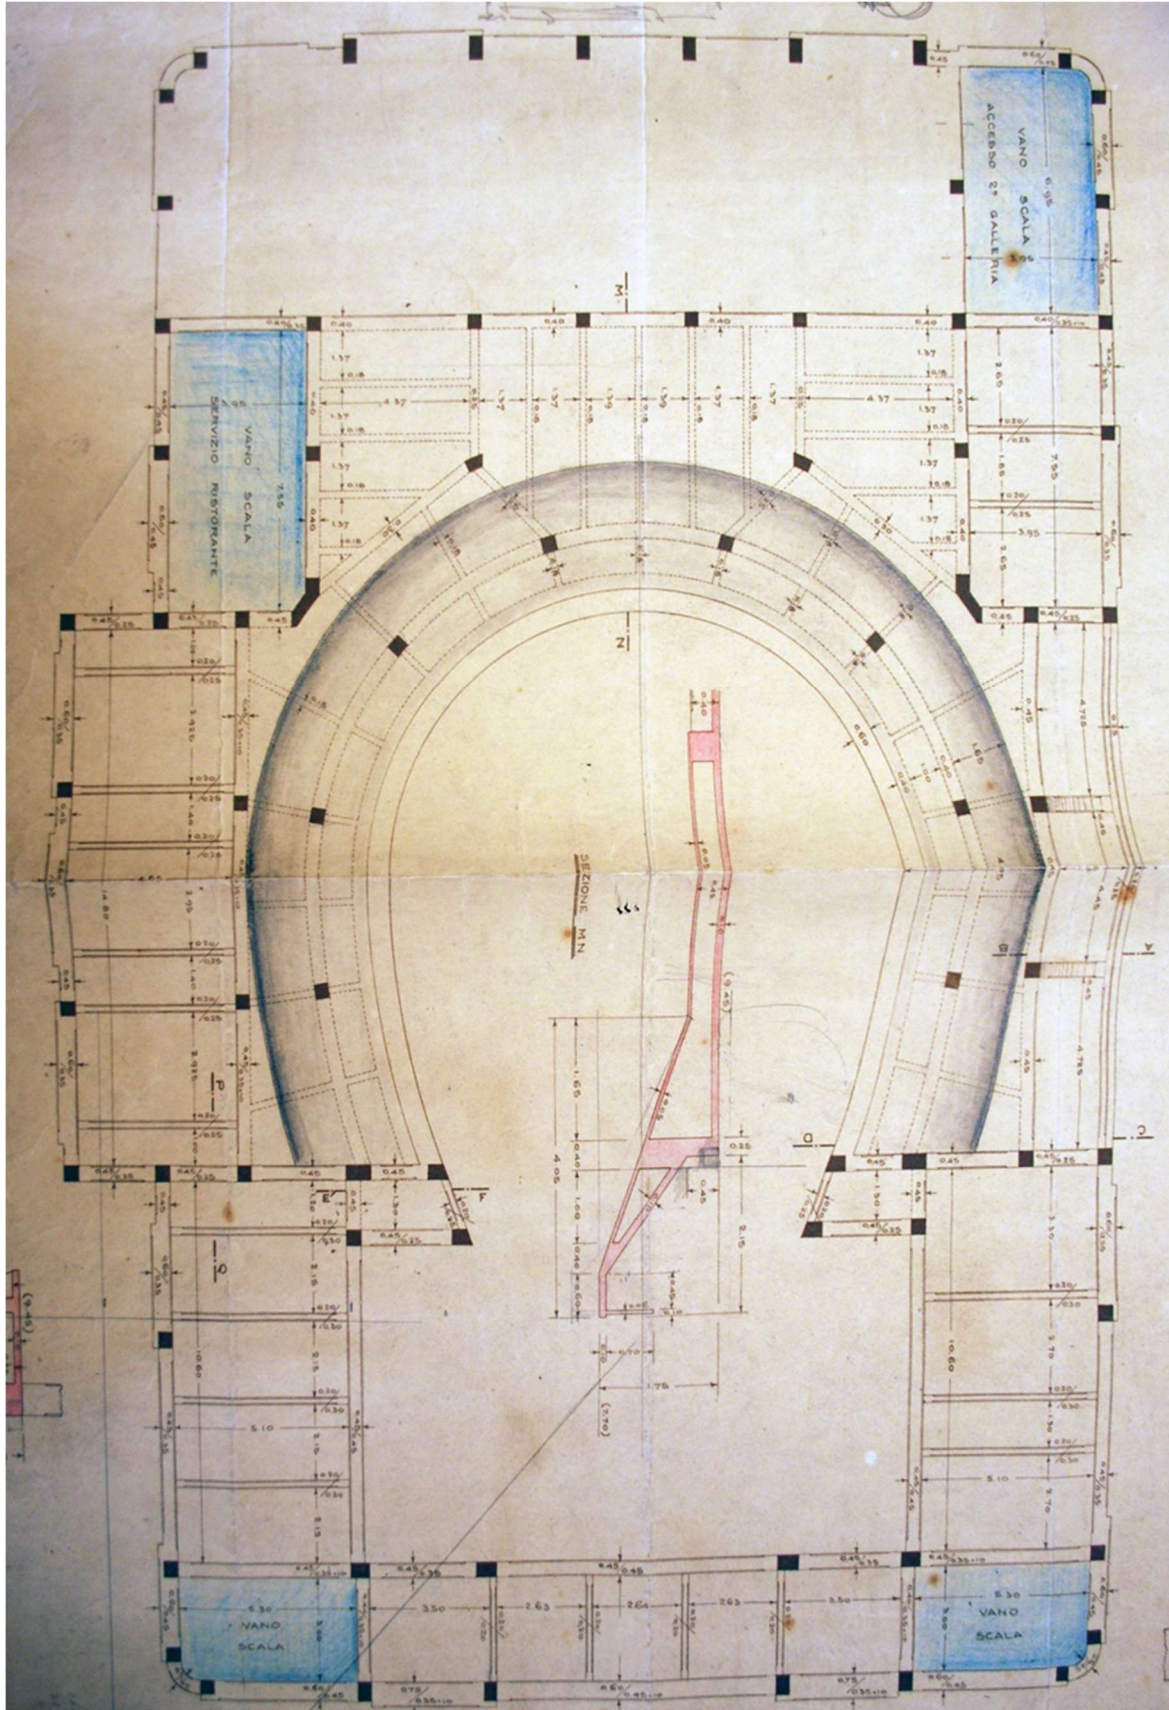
Schizzo pianta solaio seconda galleria con modifiche in corso d'opera
